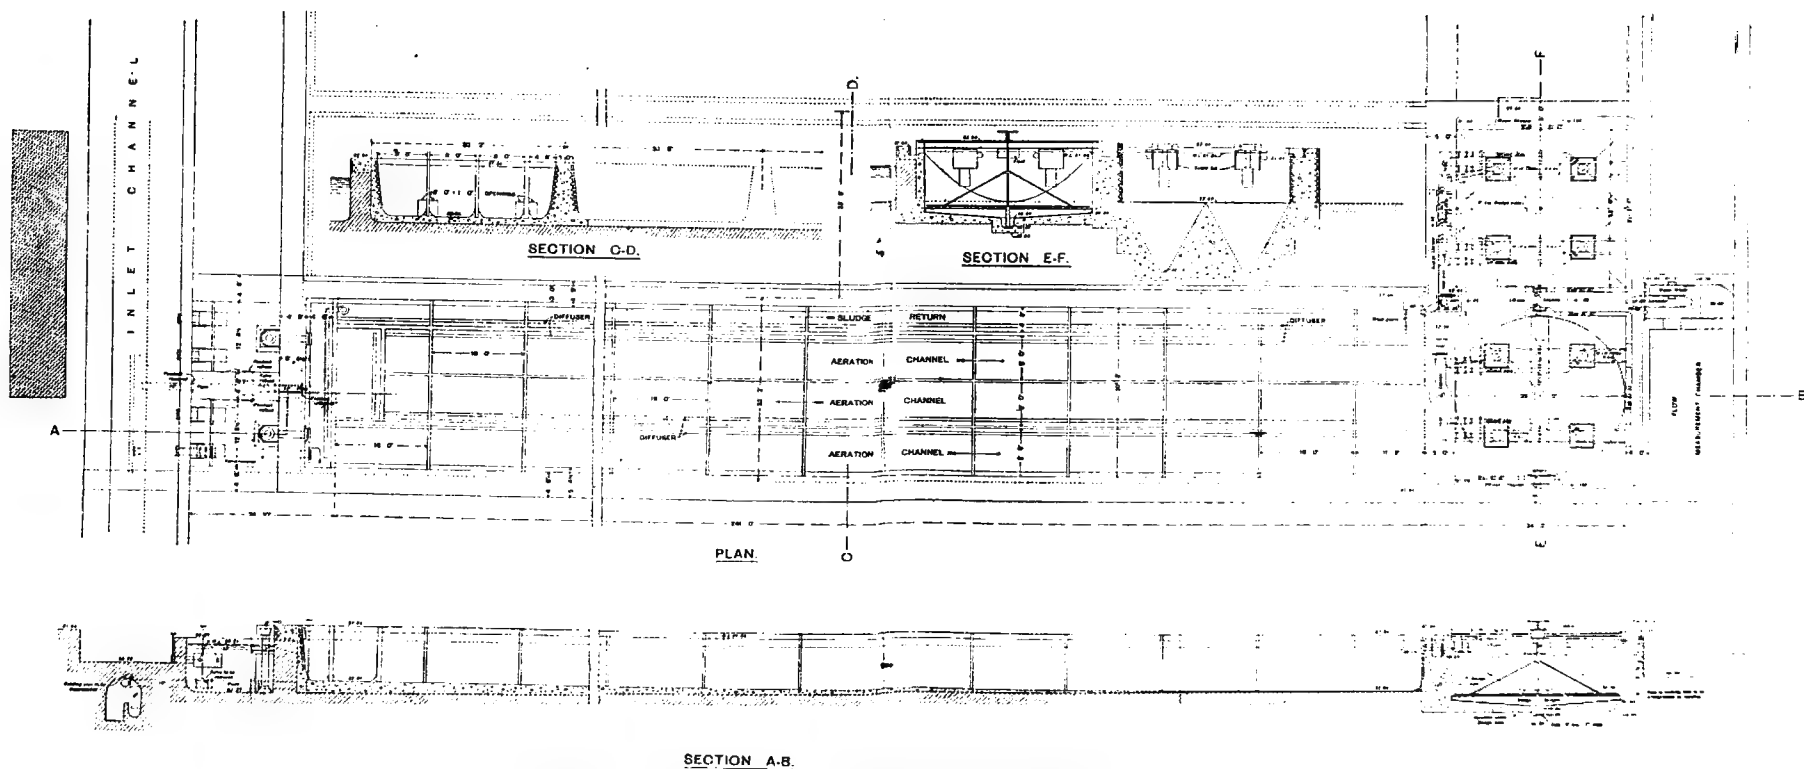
Plan général de l'installation de Manchester (Davyhulme).
